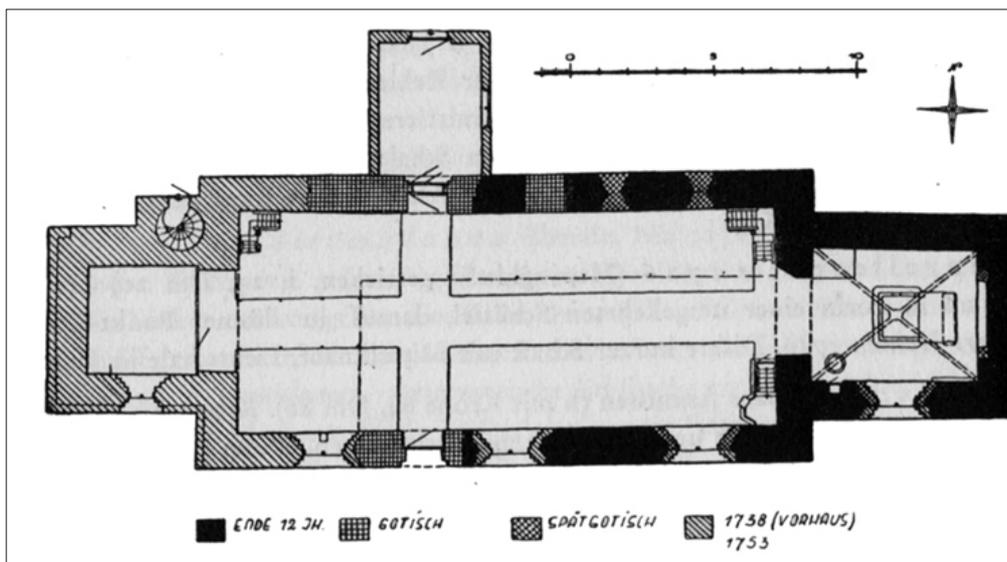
Grundriss der Steinberger Kirche 1952 (D. Ellger S. 336)
